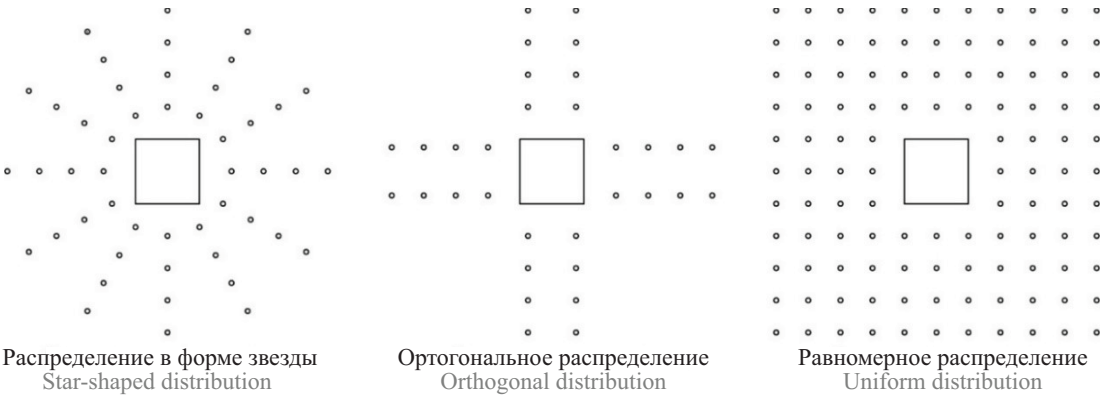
Виды распределения поперечной арматуры вокруг опоры
